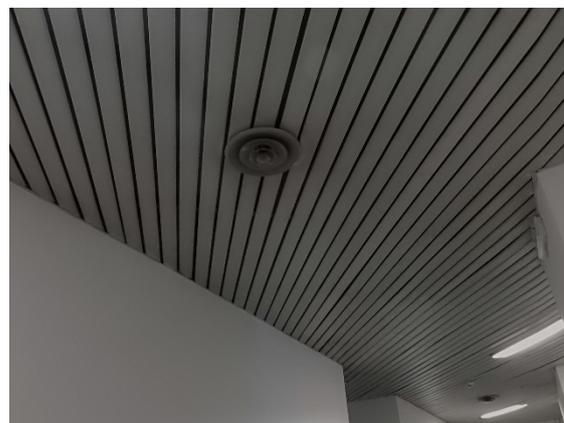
Particolare sistema emissione palestra – bocchetta su canale
